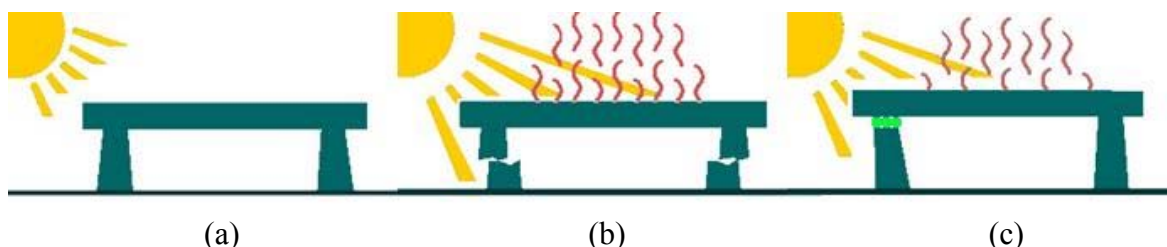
(a) Pórtico em temperatura ambiente. (b) Pórtico impedido de se deformar em uma das ligações (c) Ligação que libera a movimentação da viga do pórtico (www.pbs.org, 2007)
